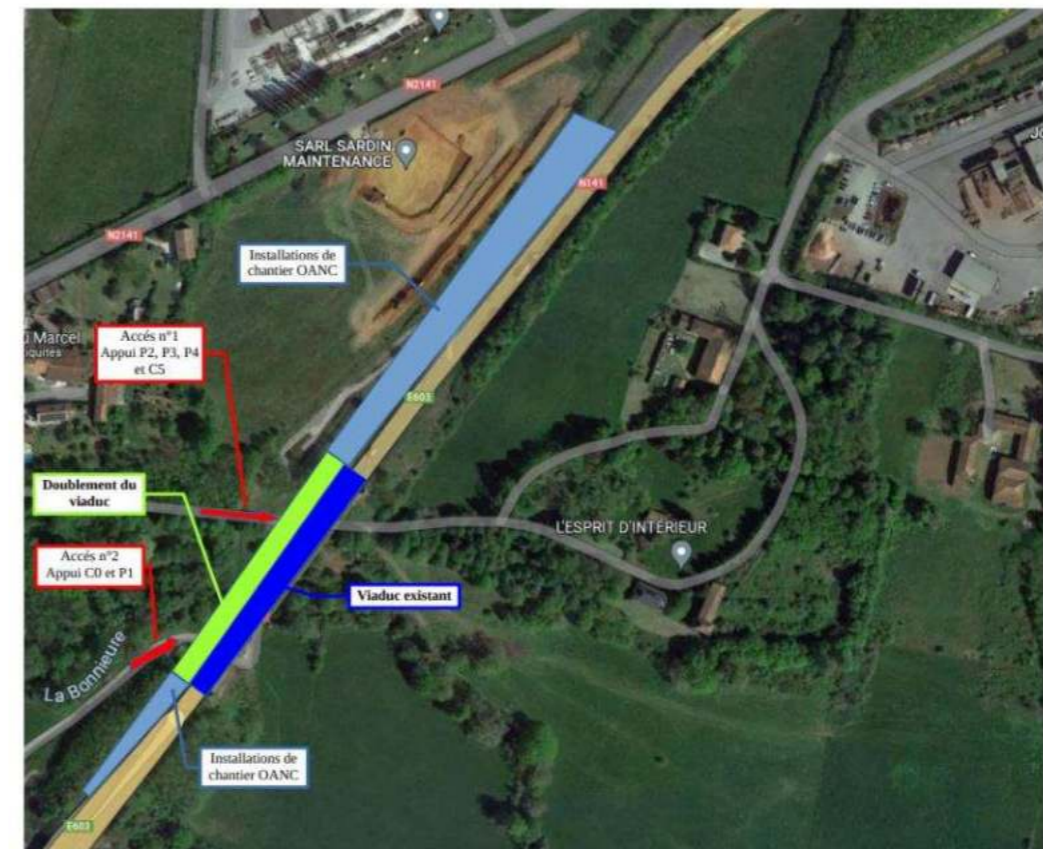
PLAN DE LOCALISATION PROBABLE DES INSTALLATIONS DE CHANTIER POUR LA CONSTRUCTION DU VIADUC
